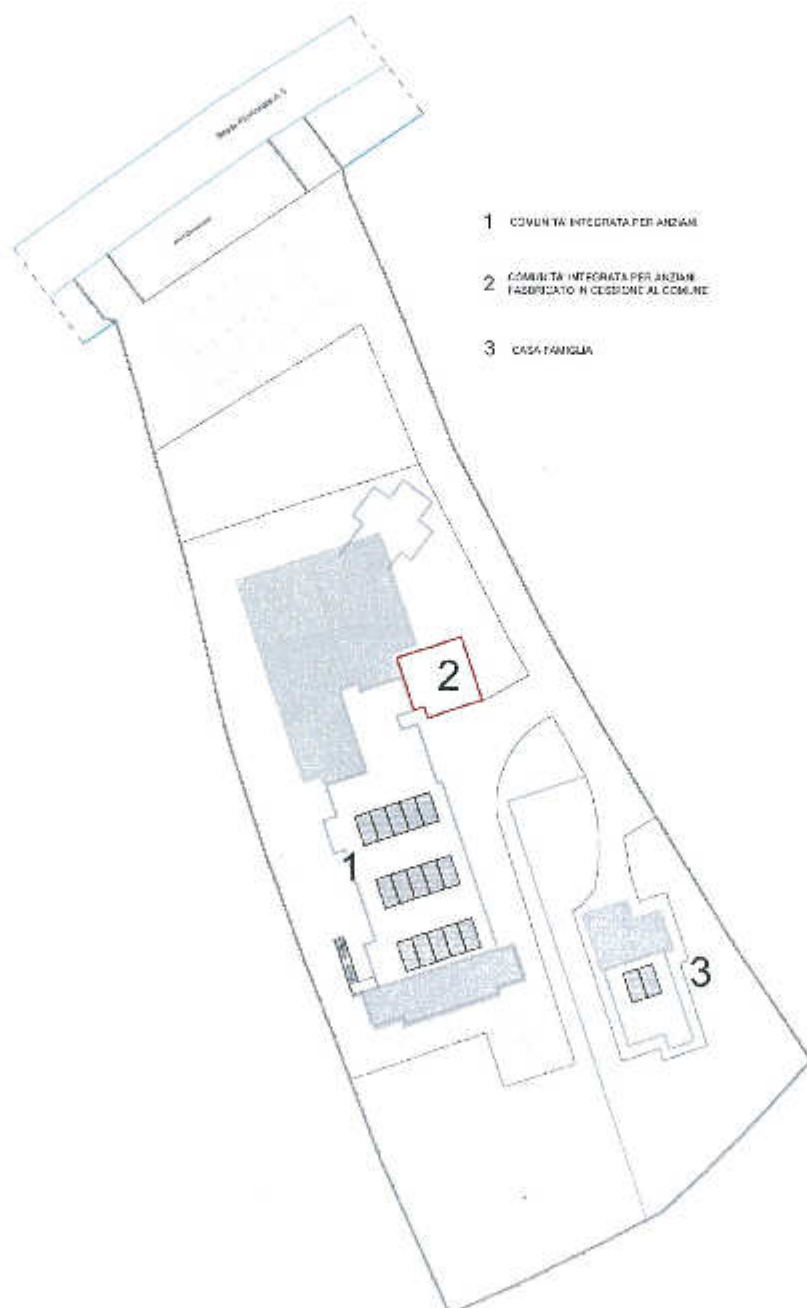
Rappresentazione planimetrica degli interventi previsti in progetto
